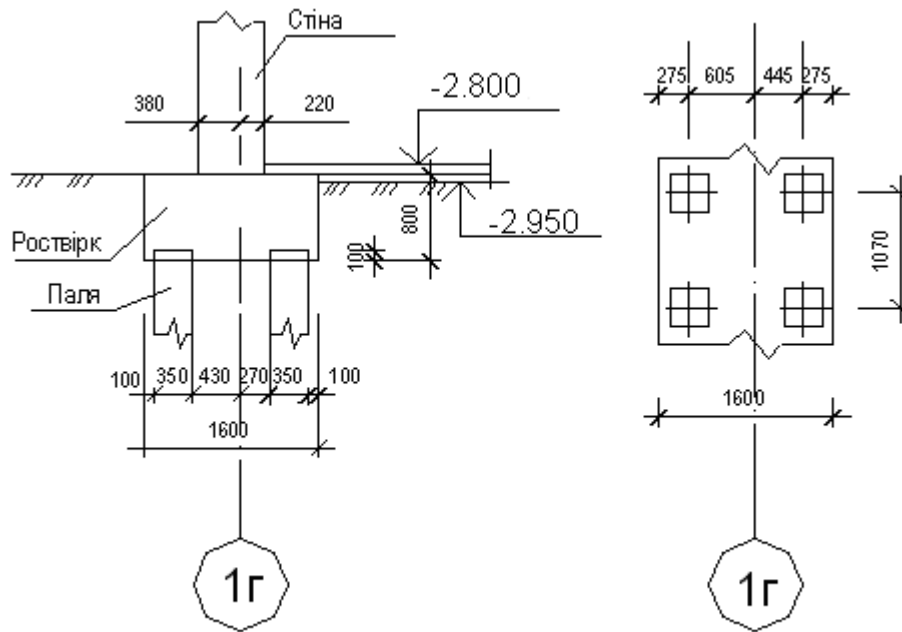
Конструкція пального фундаменту по вісі 1Г
